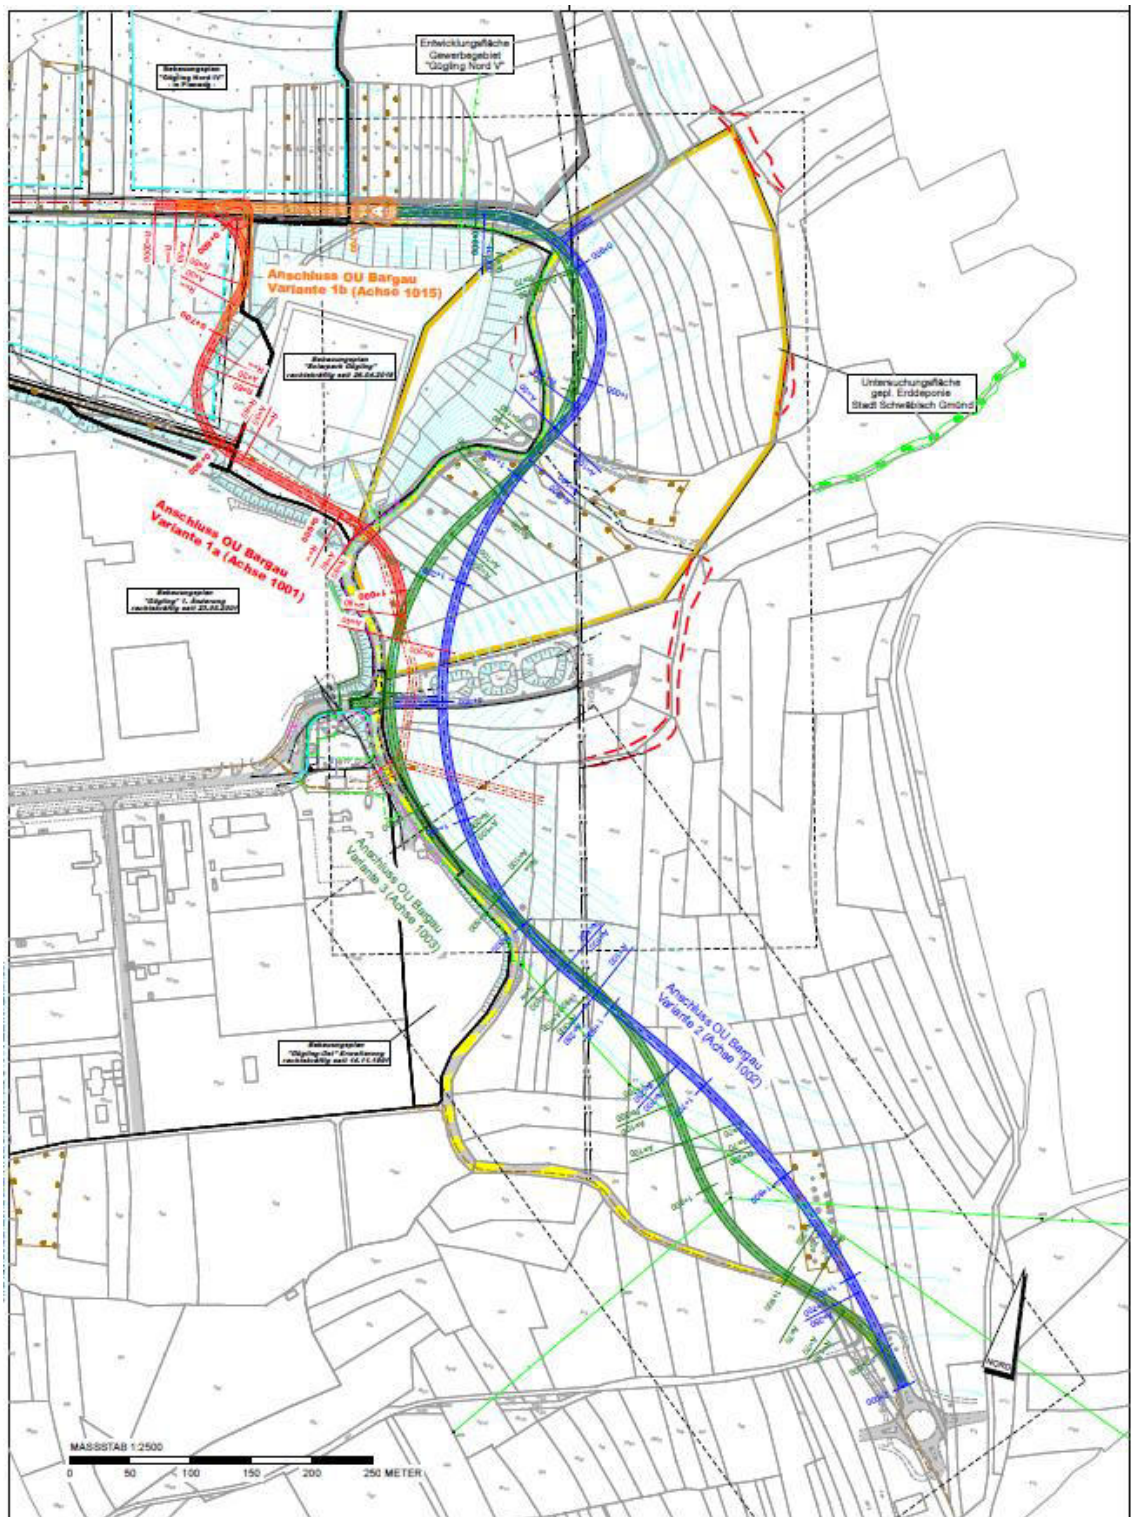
Übersichtslageplan „Trassenvarianten“, stadtländingenieure GmbH, Ellwangen, 12.12.2019
